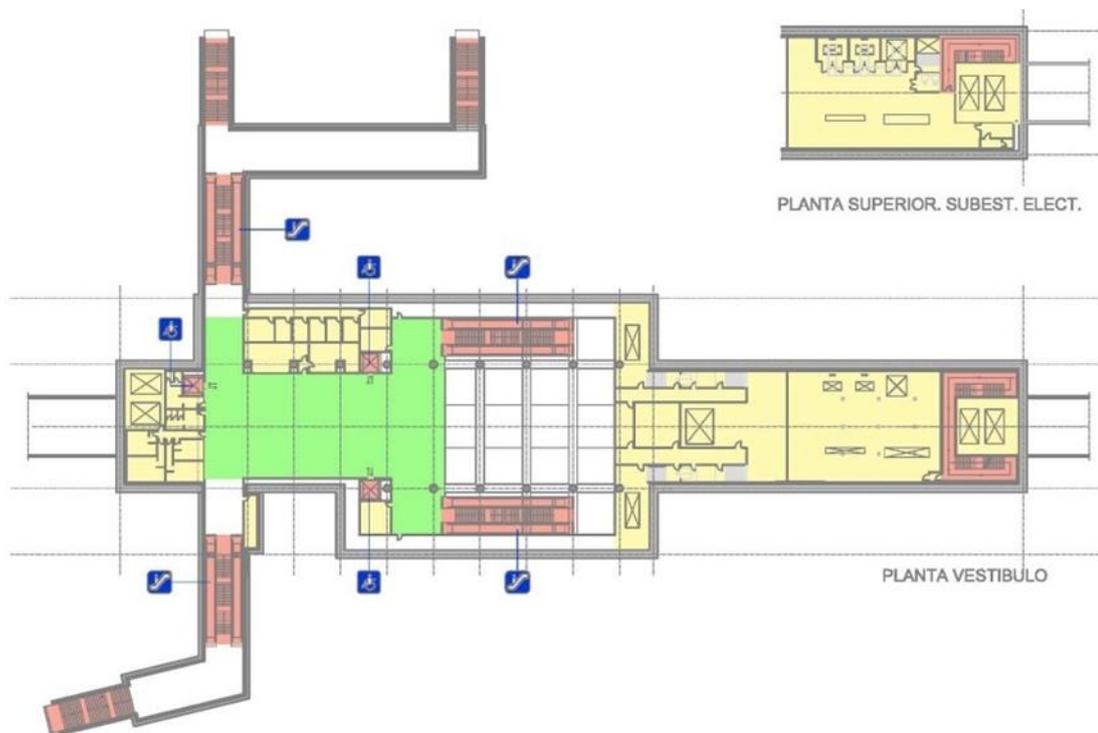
Planta de vestíbulo y subestación eléctrica de la estación de la Magdalena.
